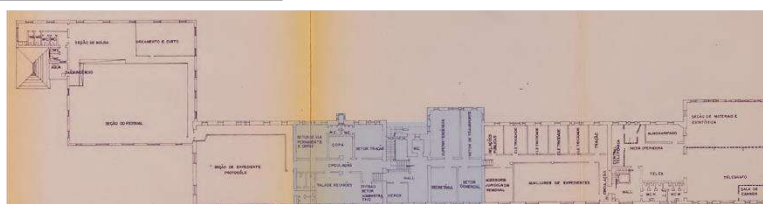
Planta do segundo edifício da estação: destaque da primeira fase construtiva.
